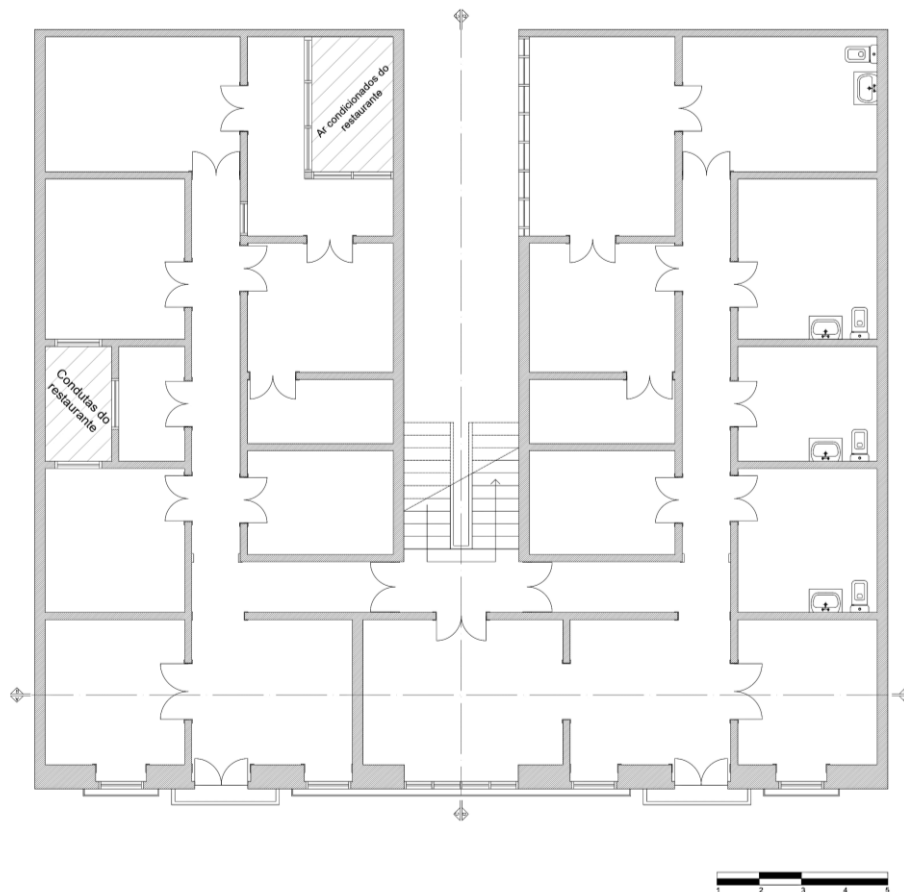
Planta existente piso 1. Fonte: Cristiana Lourinho
